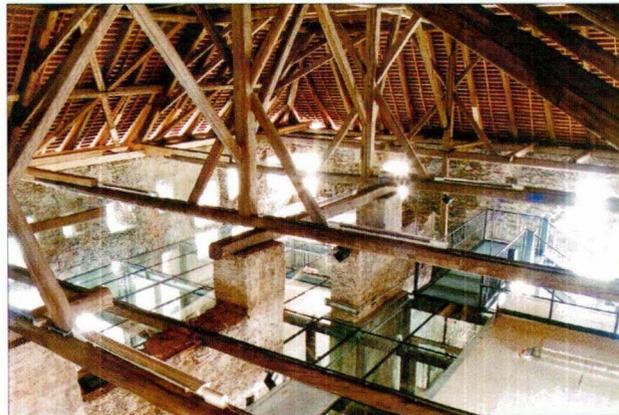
Viktring, Stiftsgebäude, Objekt, Dachraum mit „gläsernem Klassenzimmer“
